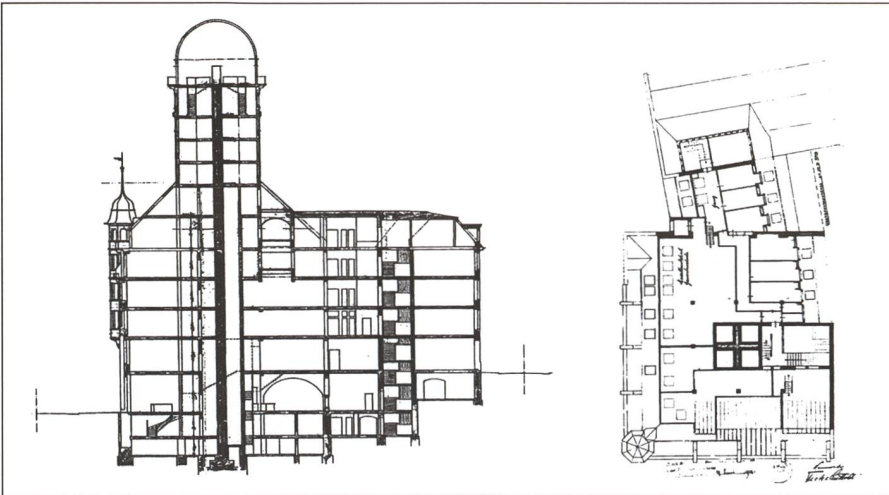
Schnitt durch das Gebäude mit dem Kuppelraum und dem Dachgeschoss-Grundriss des Geschäftshauses "Urania" mit dem kreuzförmigen Instrumentenpfeiler. Die Fundamentplatte ruht auf 48 Eichenpfählern. Fundamentplatte und Instrumentenpfeiler sind vom übrigen Gebäude getrennt, damit keine Erschütterungen auf das Instrument übertragen werden.
